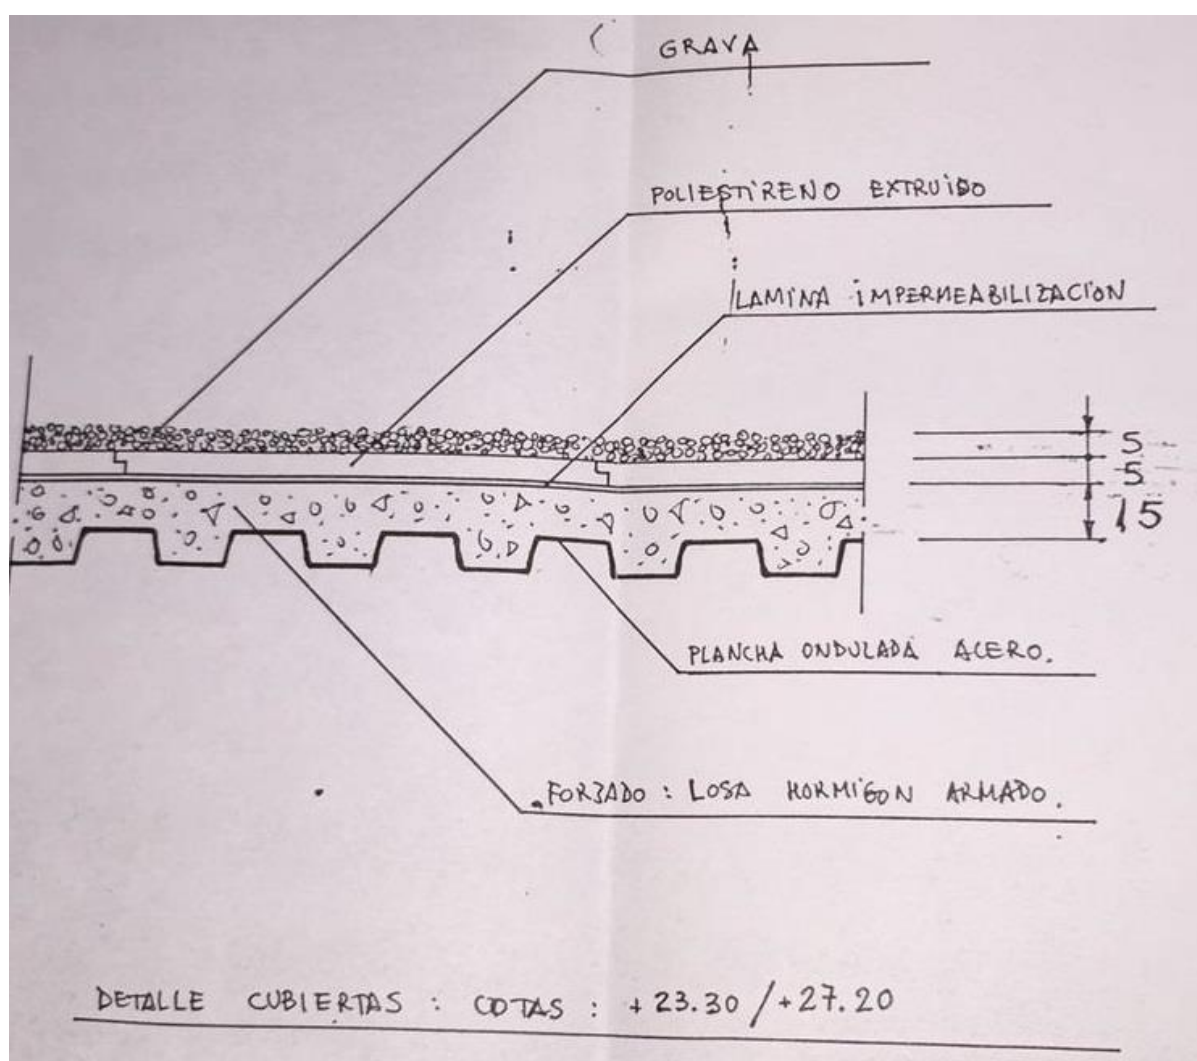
Detalle de las cubiertas de sala y caja escénica descritas en proyecto. Plano ARM-08.
